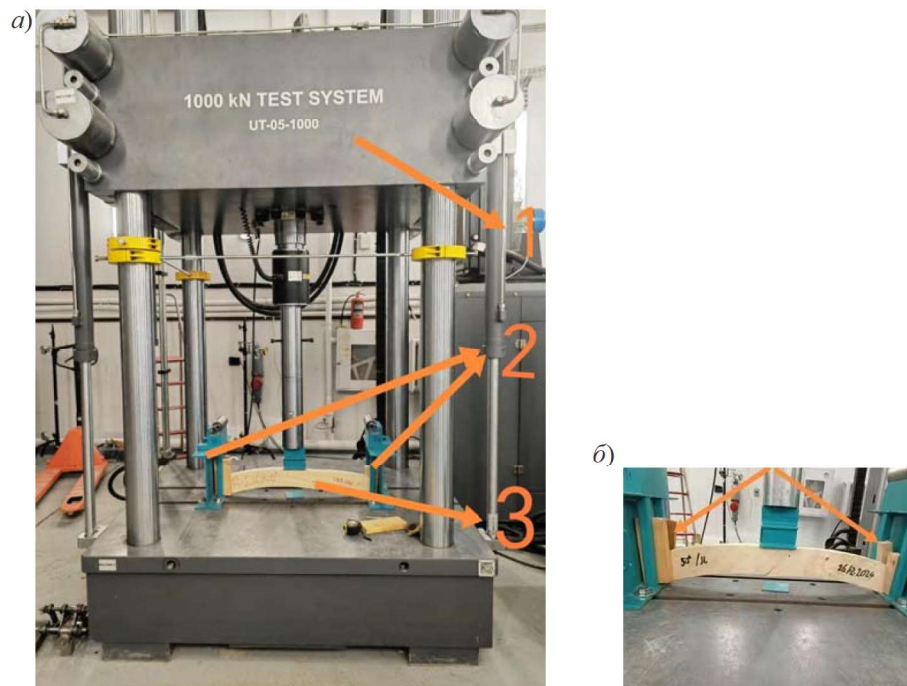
Испытание криволинейных образцов на изгиб: а — образец в процессе испытания (1 — испытательная машина Magnum UT-05-1000; 2 — металлические упоры; 3 — криволинейный образец из LVL (X)); б — установка и раскрепление образцов
